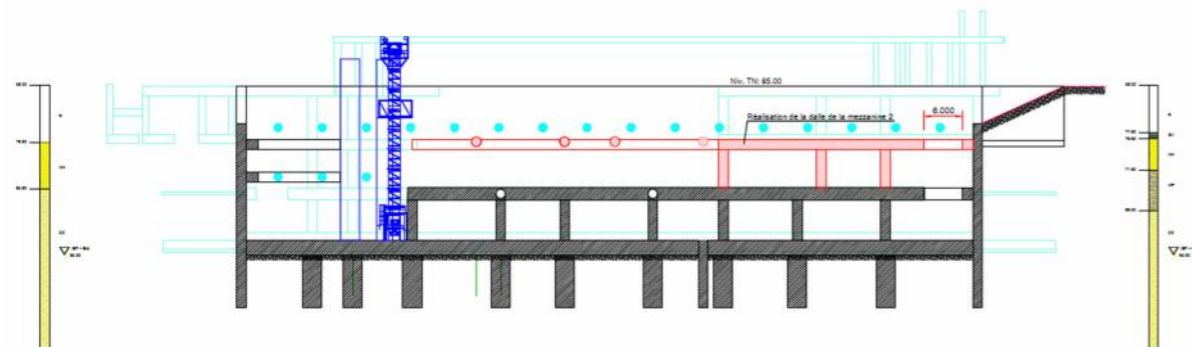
Bétonnage dalles et poteaux des mezzanines 1 et 2
